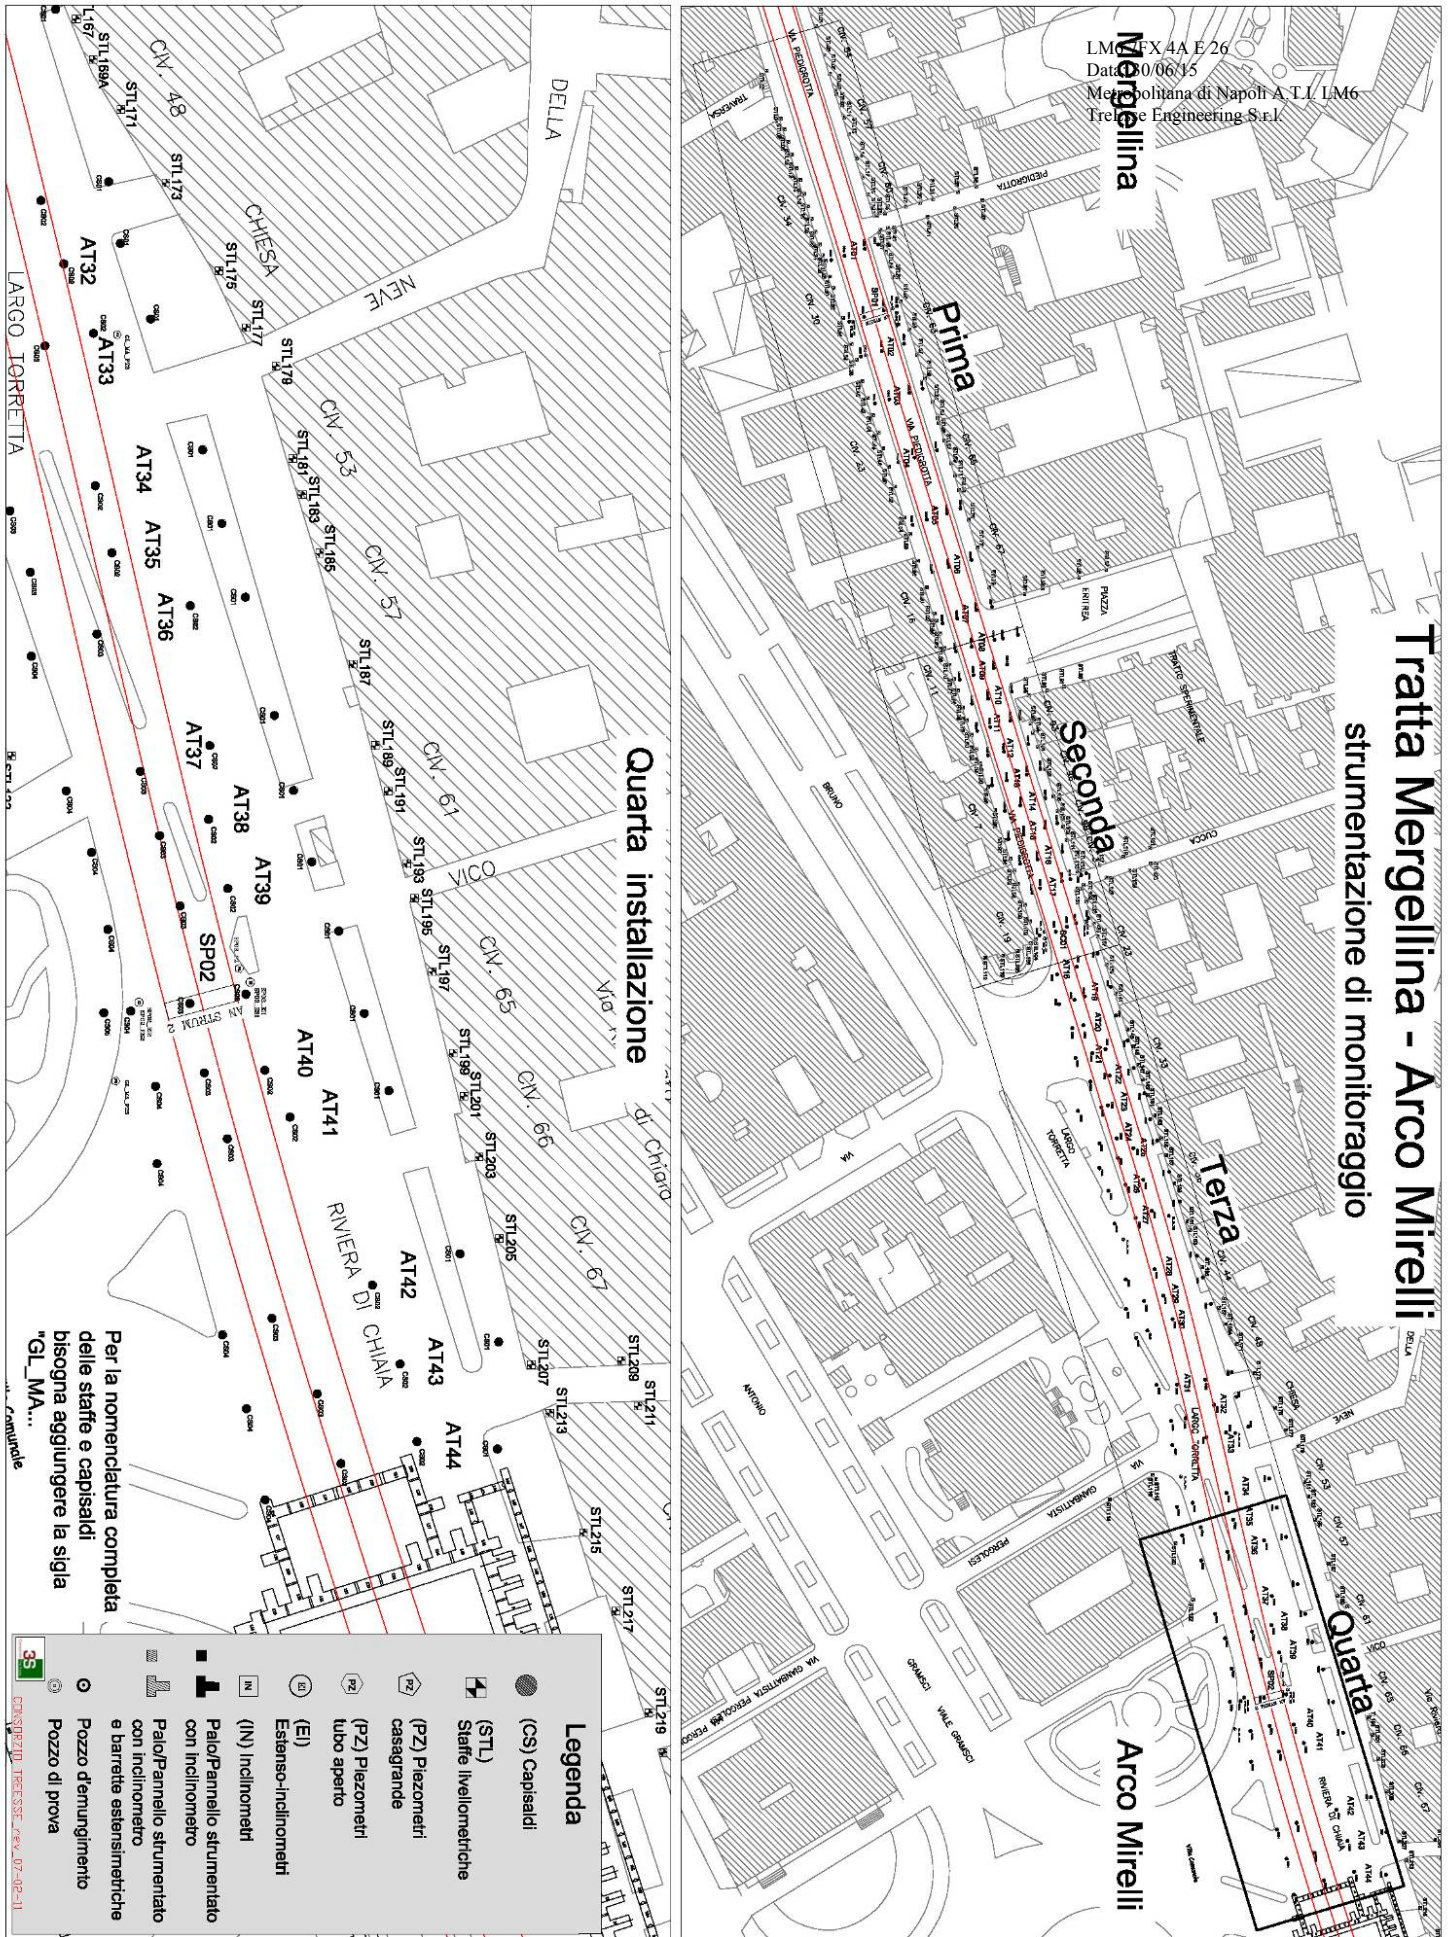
Planimetria tratta Mergellina - Arco Mirelli, raffigurante la disposizione della quarta installazione della strumentazione di monitoraggio.
